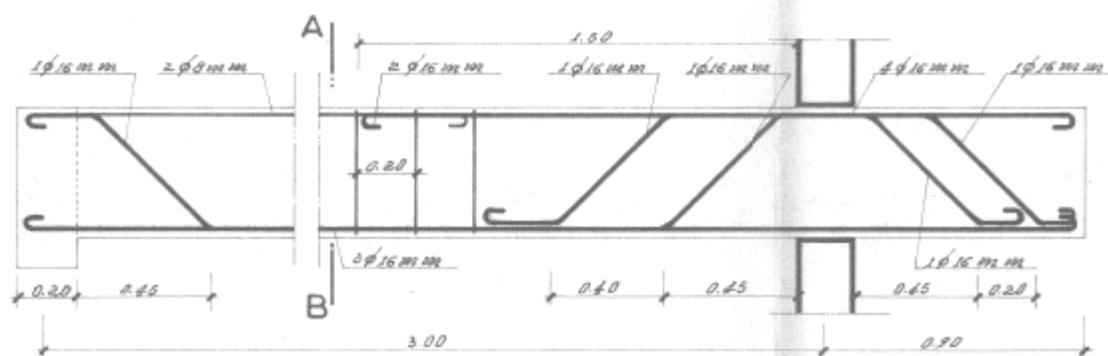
Pormenorização das armaduras: Vigas V7, V8, V9. (Projetos Originais)
